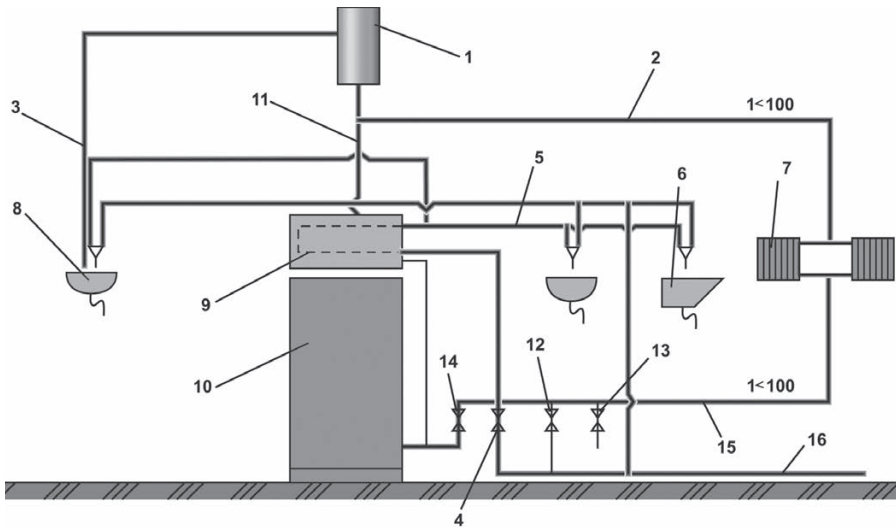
Схема монтажа для зимнего отопления: 1 — расширительный бачок; 2 — подающий трубопровод; 3 — переливная труба; 4 — вентиль водонагревателя; 5 — трубопровод горячей воды; 6 — ванная; 7 — радиаторы; 8 — раковина; 9 — водонагреватель; 10 — котел; 11 — главный стояк; 12 — вентиль для подпитки системы; 13 — спускной вентиль; 14 — вентили; 15 — обратный трубопровод; 16 — водопровод
